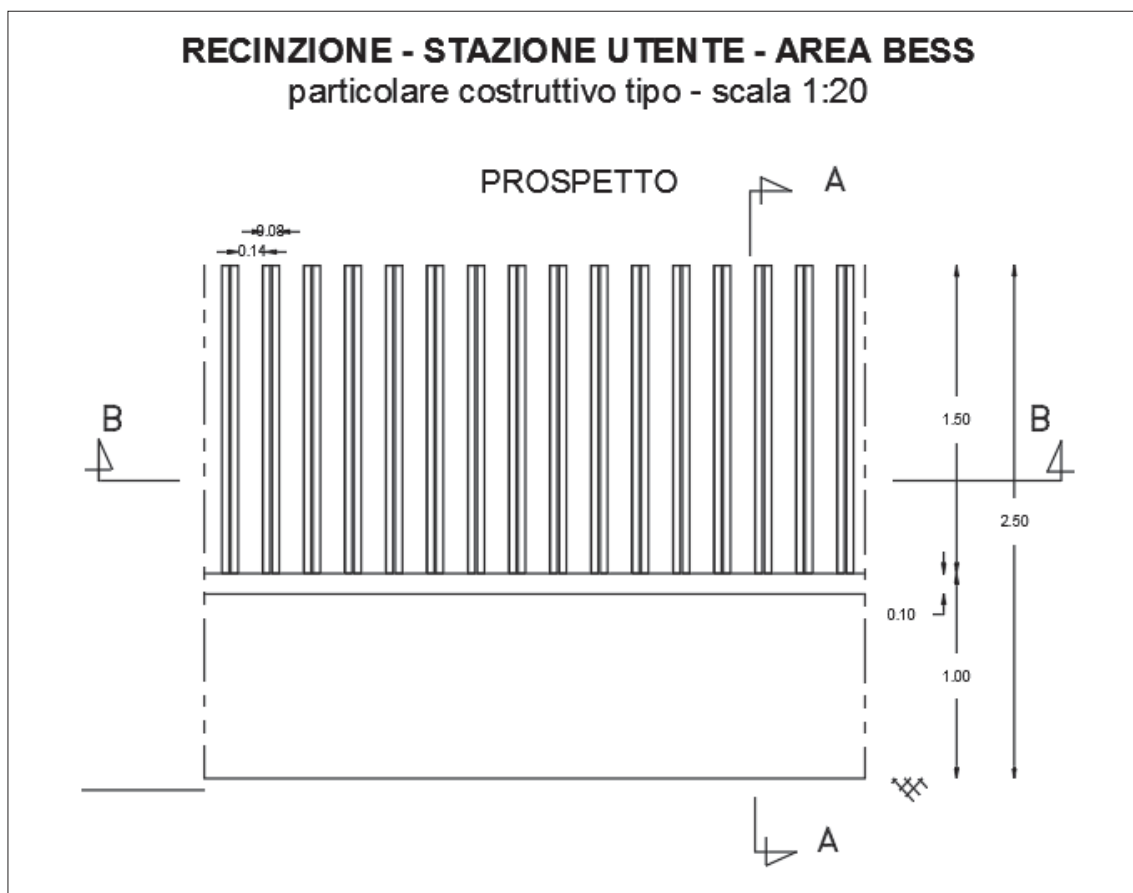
Tipologico -Prospetto Recinzione Area BESS e Area SSU
